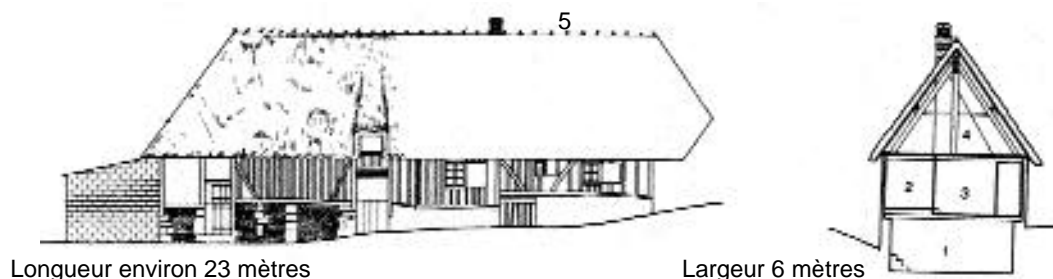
L'analyse d'une chaumière rurale du marais Vernier dans un dictionnaire d'architecture [41 p. 206], façade nord-ouest (à gauche) et coupe transversale (à droite). 1-cafoutin 2-débarras 3-chambre 4-grenier 5-iris sur le toit.
